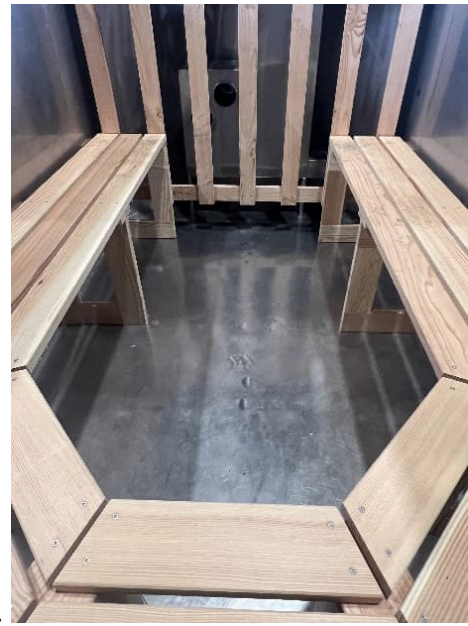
Einpassen und Montage der Sitzbänke im Hot-Tub
